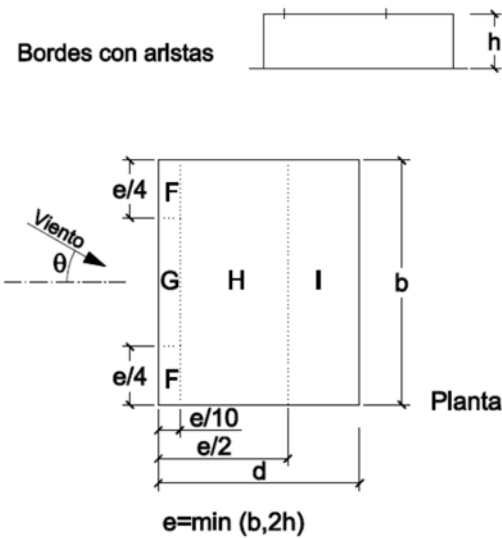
Áreas de presión exterior en cubierta plana nave 1.
